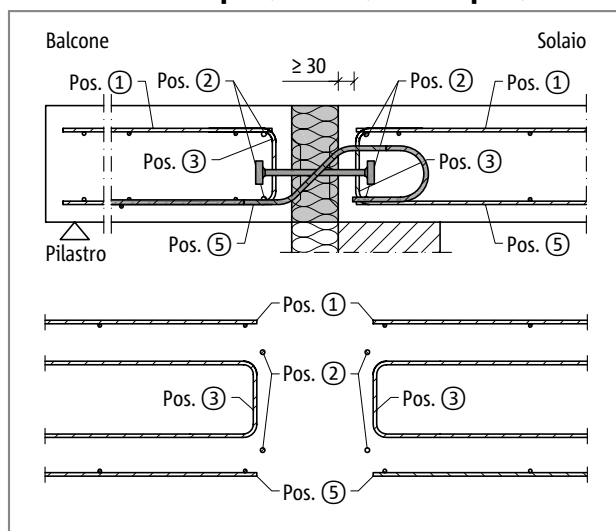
Schöck Isokorb® tipo QP, armatura in opera
